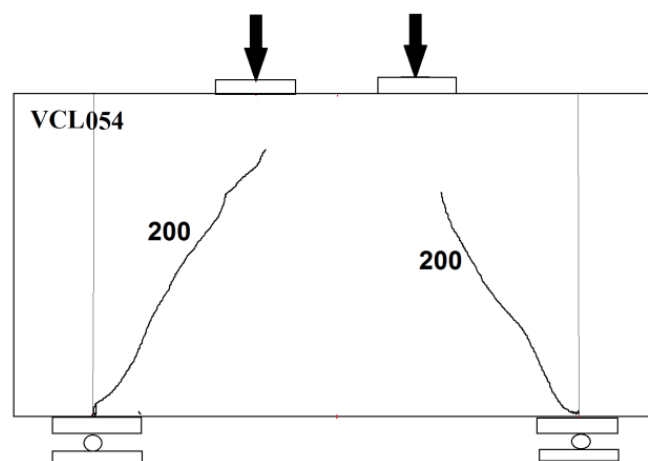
Esquema de fissuração da viga VCL054.
